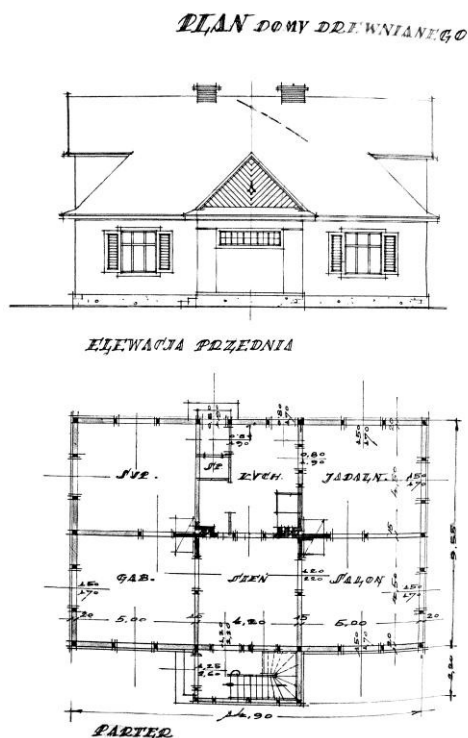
Проект дерев'яного житлового будинку поручика М.Фабіана на ділянці №32 офіцерської колонії. Головний фасад, план першого поверху. 1928. [9]
